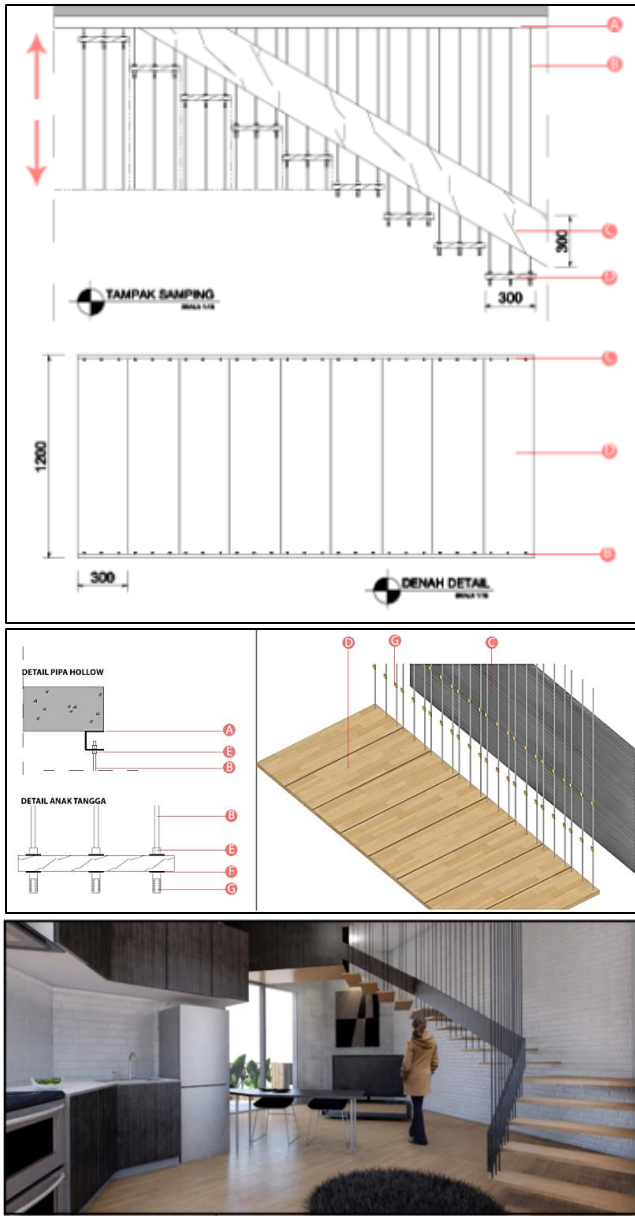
Konstruksi bidang pada lantai tipikal
